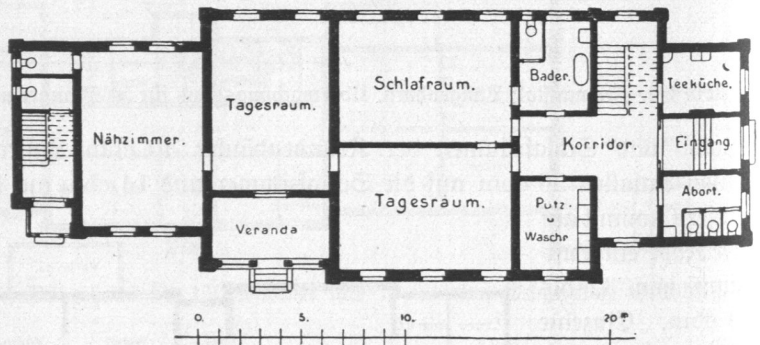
Irrenanstalt Langenhorn, Landhaus für Frauen, Erdgeschoß, Grundriß.
